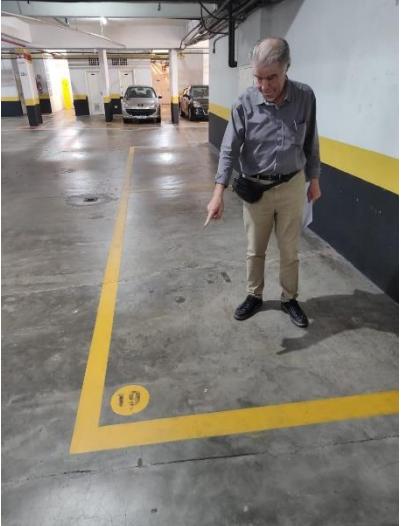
Vaga n.º 19 no primeiro subsolo.
